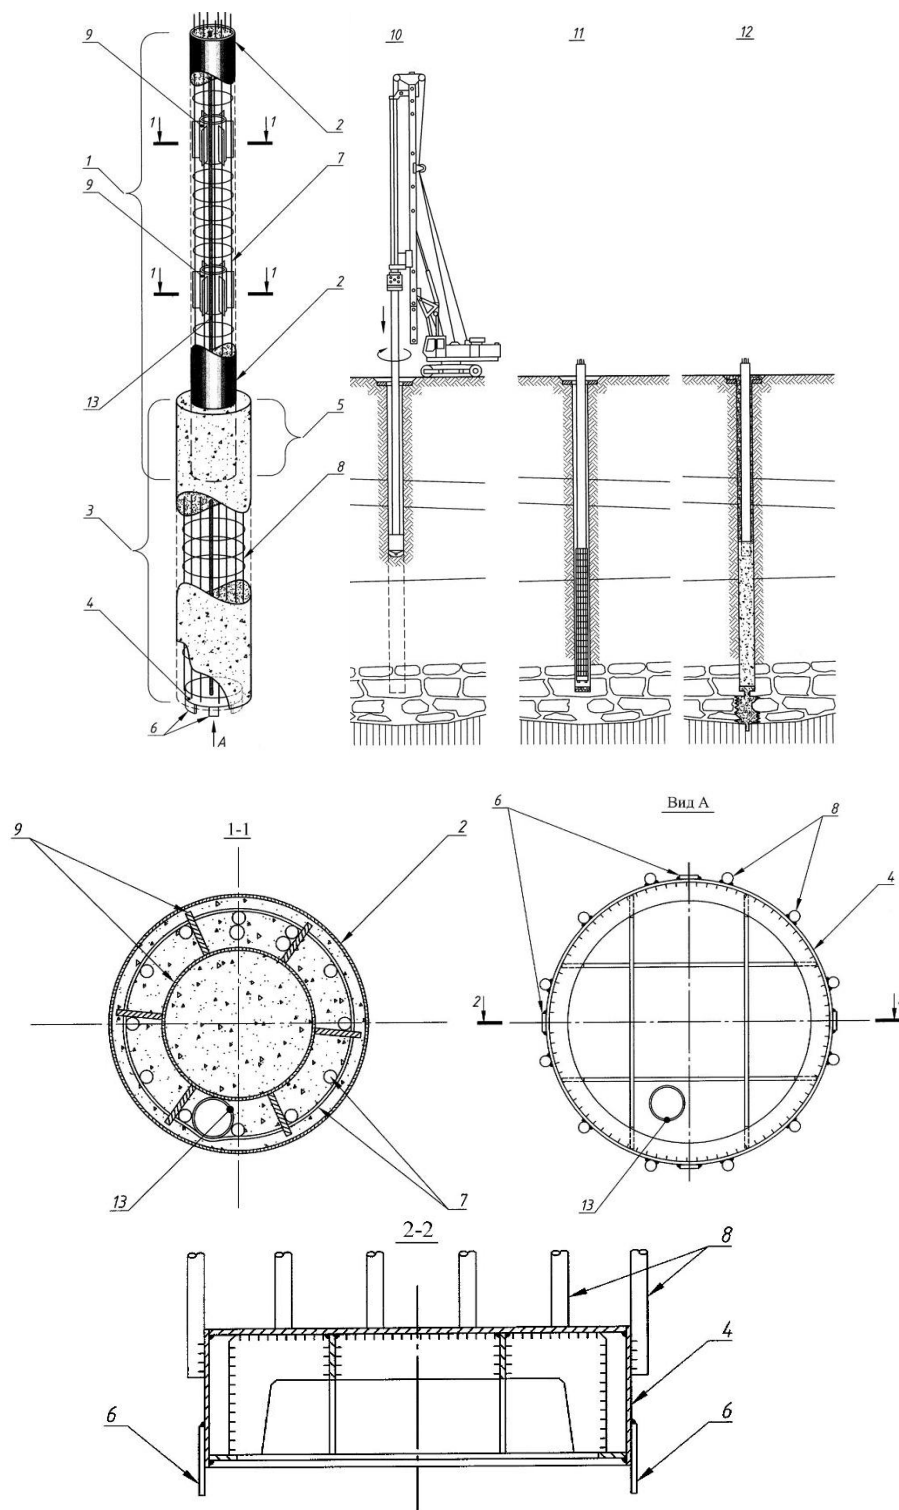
Конструкция железобетонной буровой колонны: 1 – верхняя опорная часть колонны; 2 – неизвлекаемая опалубка; 3 – нижняя фундаментная часть колонны; 4 – призабойная камера; 5 – заделка; 6 – фиксаторы; 7 – арматурный каркас (верхняя часть); 8 – арматурный каркас (нижняя часть); 9 – закладная деталь с радиальными ребрами; 10 – бурение скважины; 11 – погружение и центрирование арматурного каркаса; 12 – замоноличивание колонны; 13 – технологический трубопровод для выполнения уширения и цементации грунтового основания.
